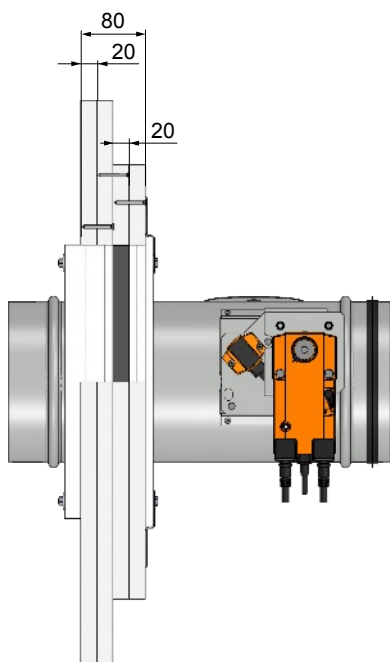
Šachtová konstrukce - instalační rám R1 - KRUHOVÁ Klapka
